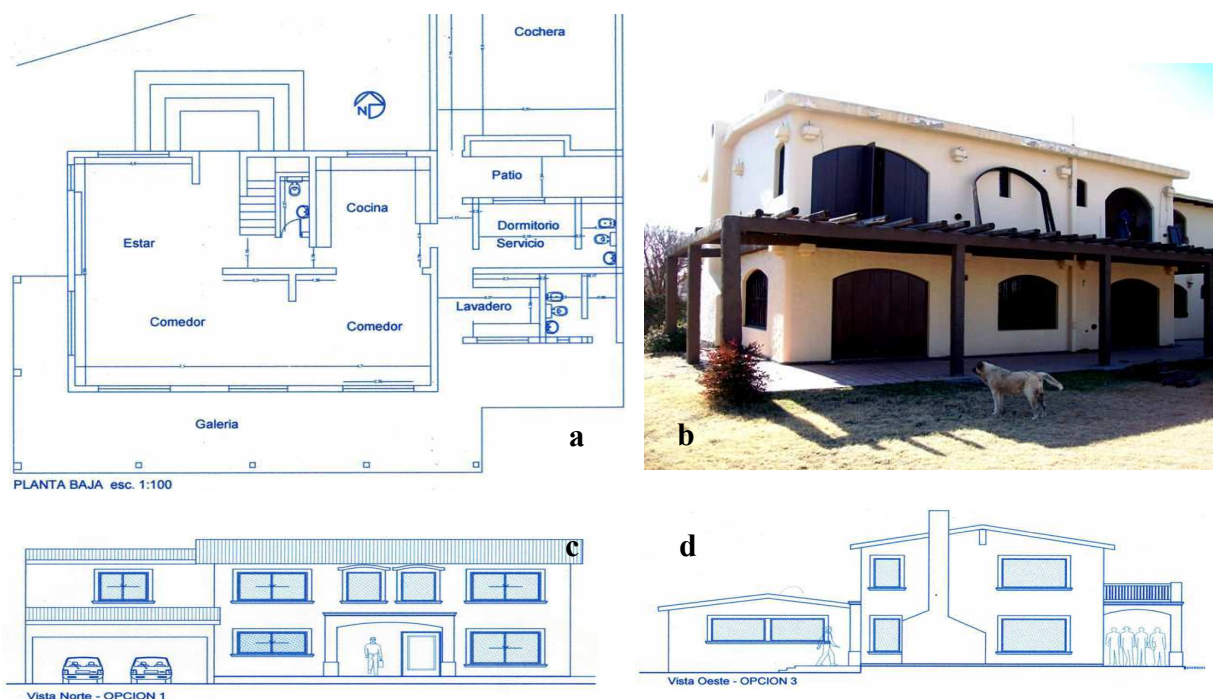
Vivienda del Caso B: a- planta; b- foto fachada sur; c- vista proyecto de fachada norte refaccionada; d- vista del proyecto de fachada oeste refaccionada.
